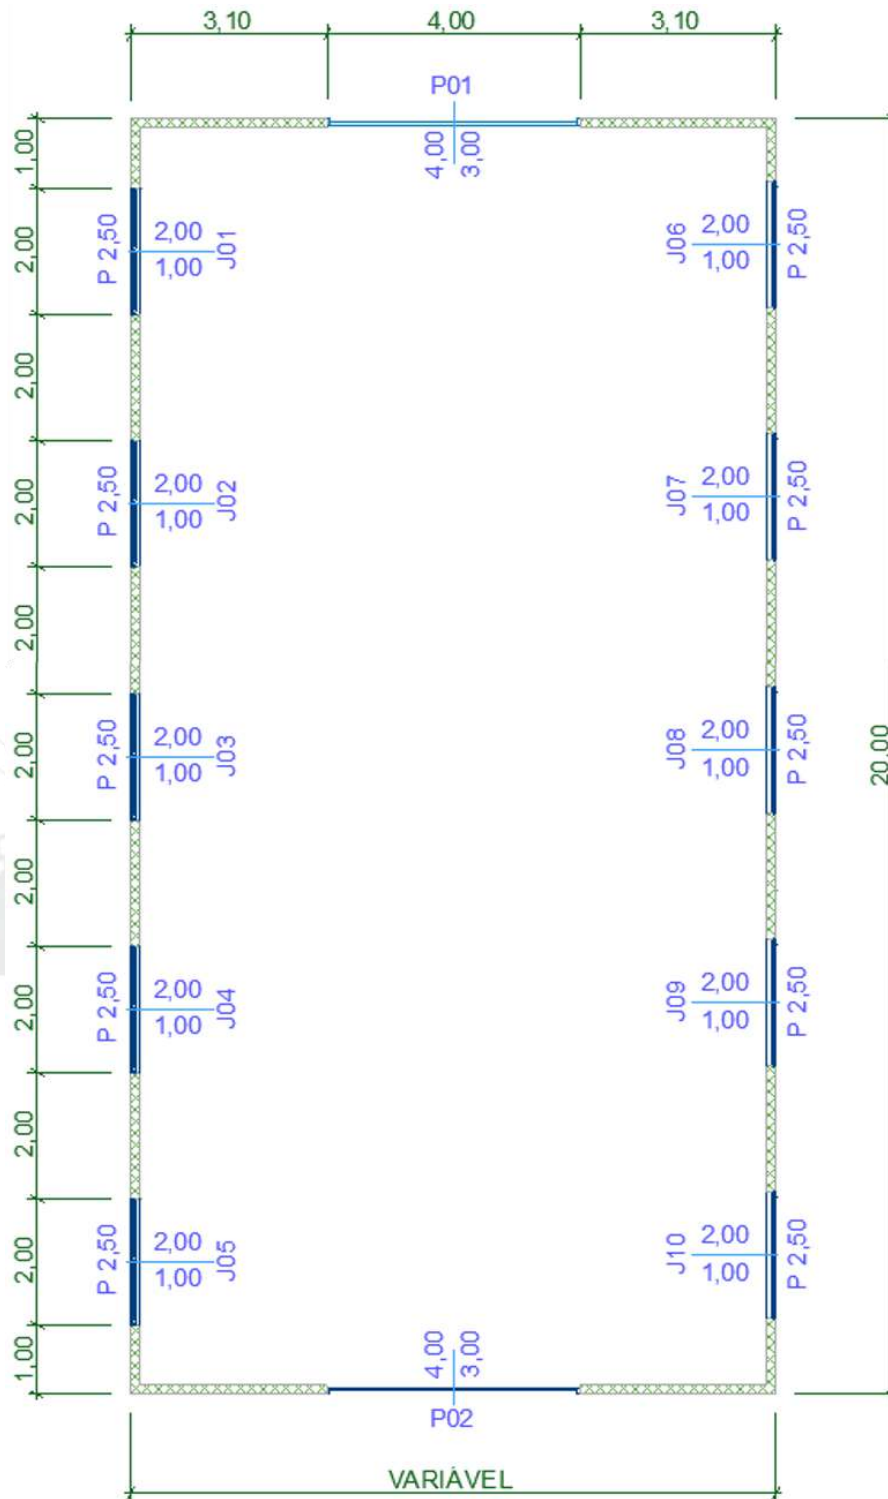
Planta baixa do projeto do galpão industrial (dimensões em metros).
